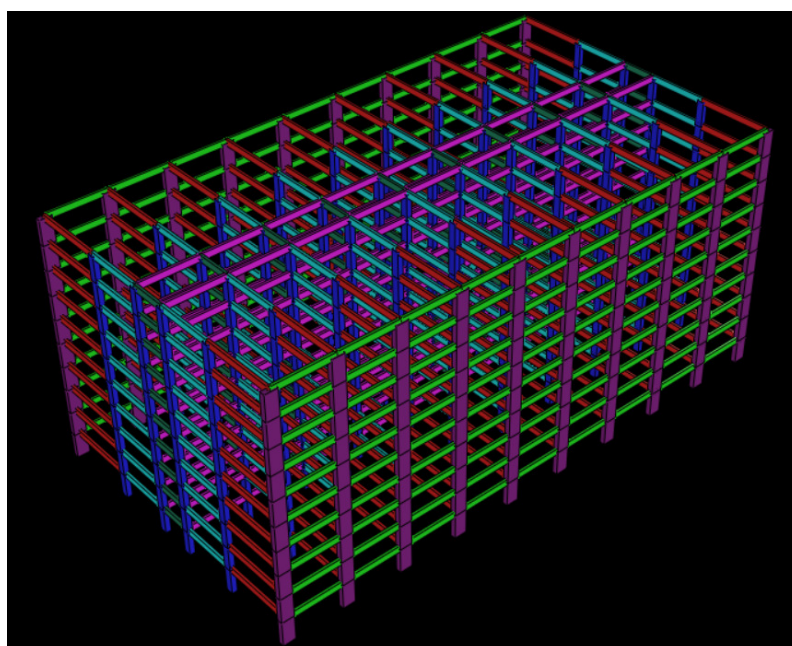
Pórtico espacial do edifício garagem contraventado por ligações semirrígidas.
